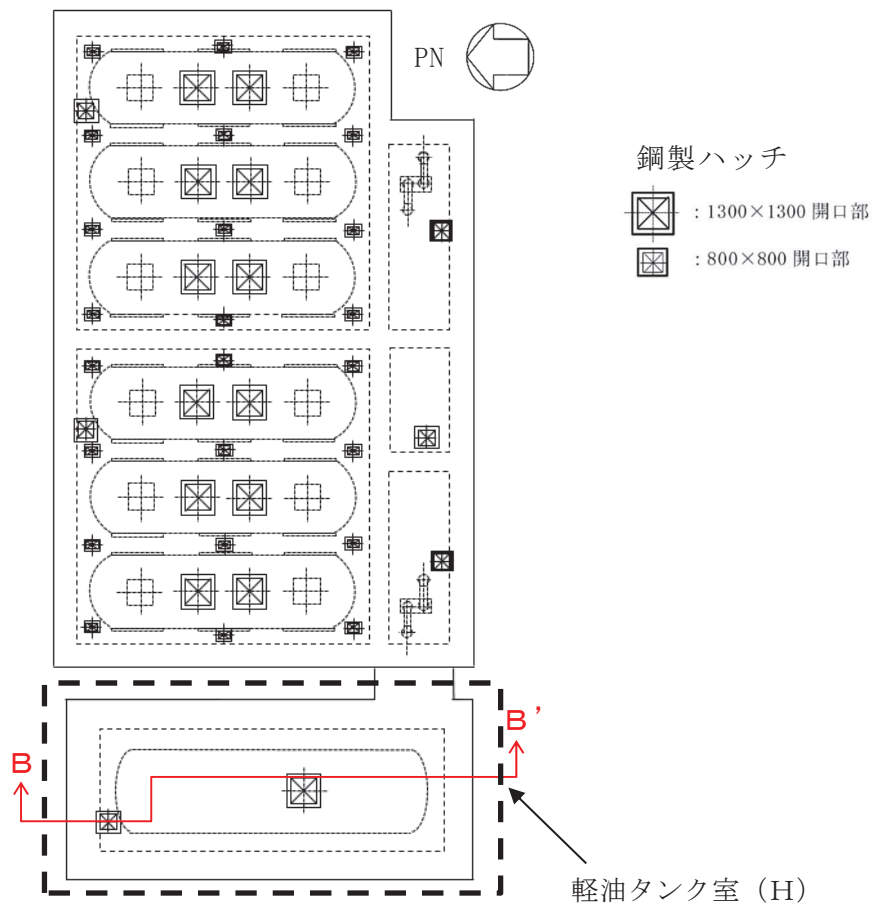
軽油タンク室 (H) の概略平面図 (O.P. 14.80m)
